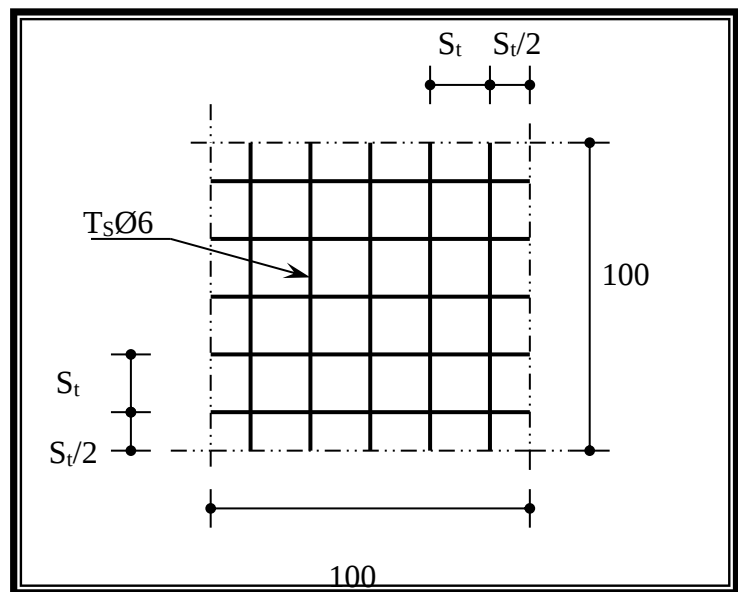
Disposition constructive des armatures de la dalle de compression
